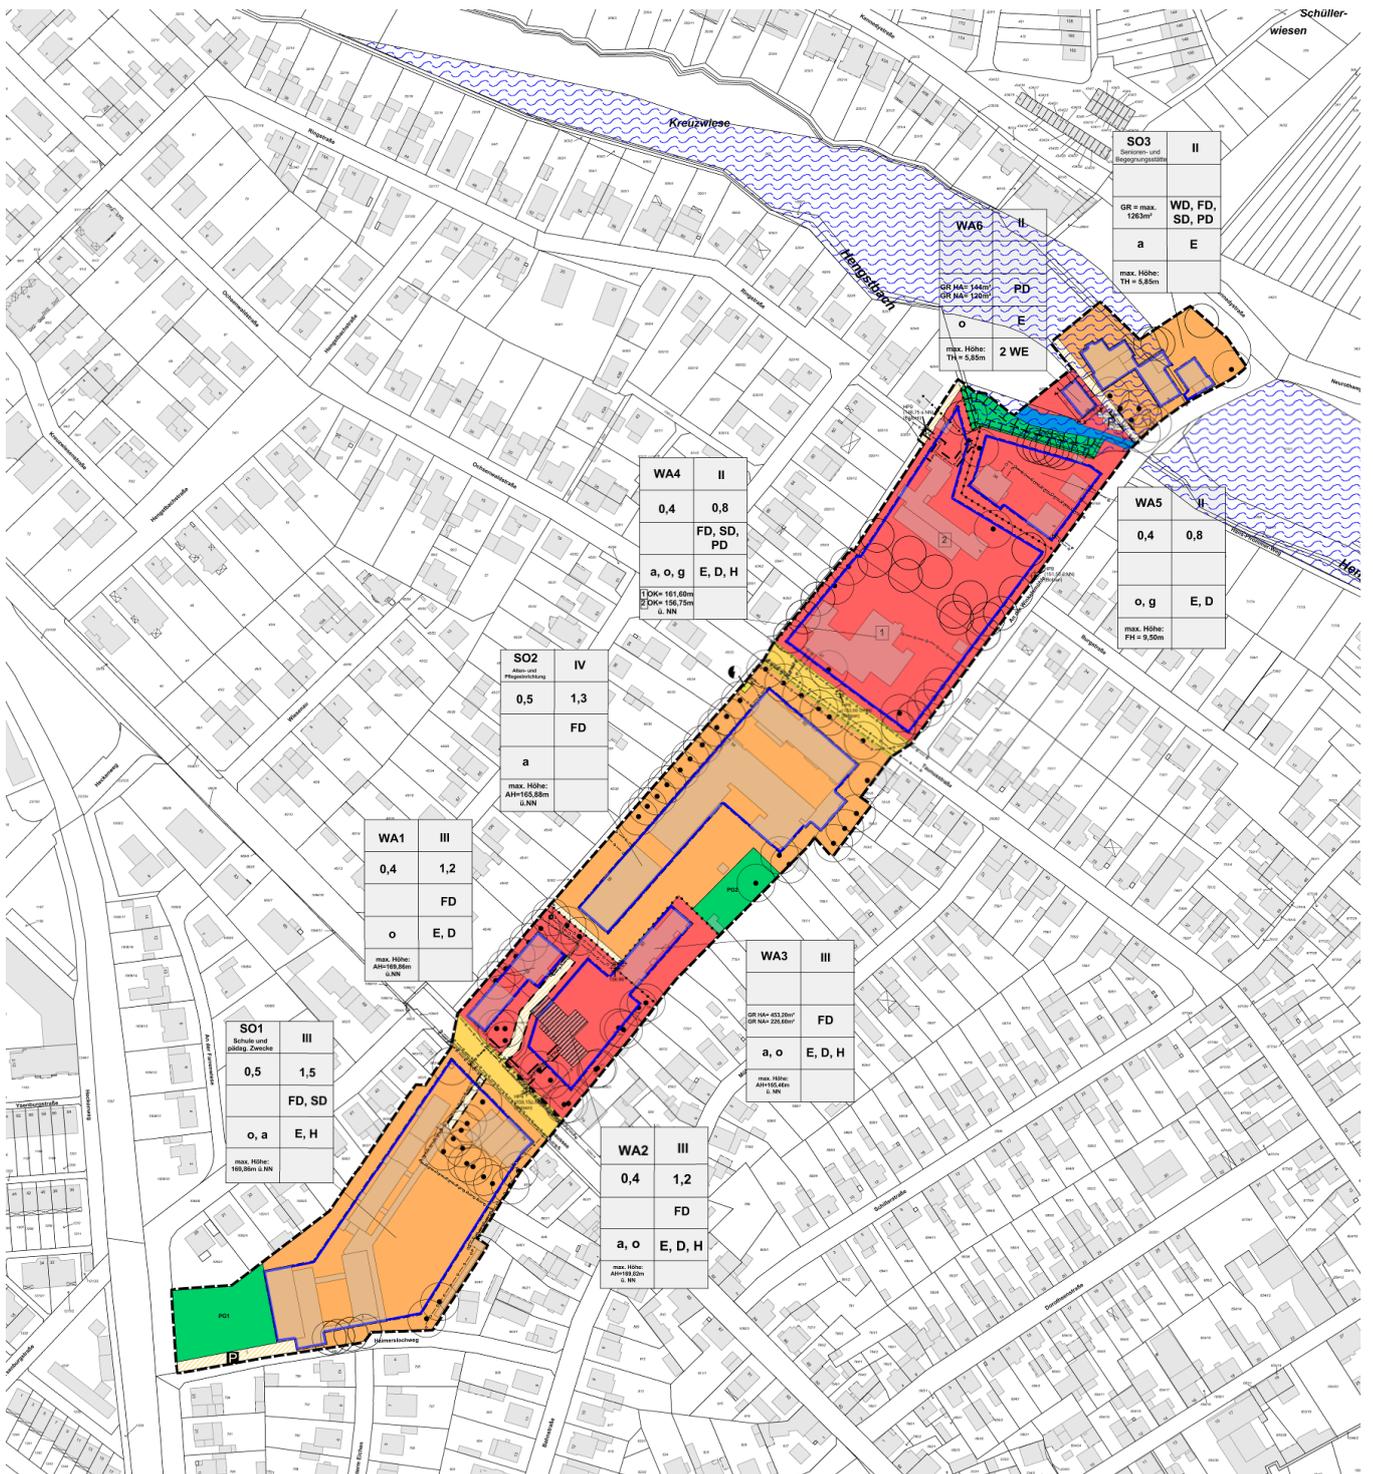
Bebauungsplan 2/16 "Im Dietrichsroth – Dreieichenhain" der Stadt Dreieich (Entwurf, Stand: Mai 2017). Ausschnitt aus der Planzeichnung, vgl. /2/, © Stadt Dreieich
